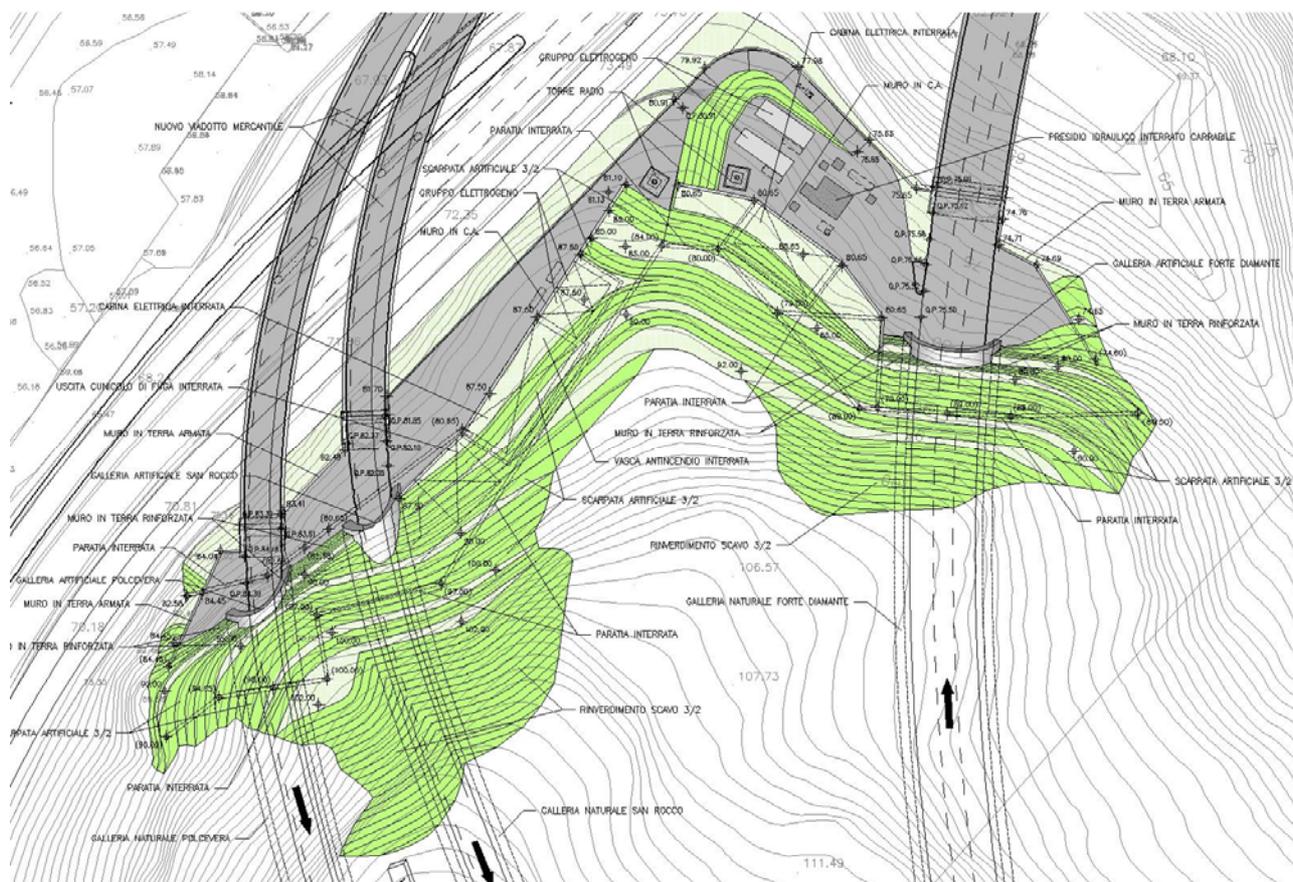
Planimetria dell'area d'imbocco (cfr. AUA0156-1)
